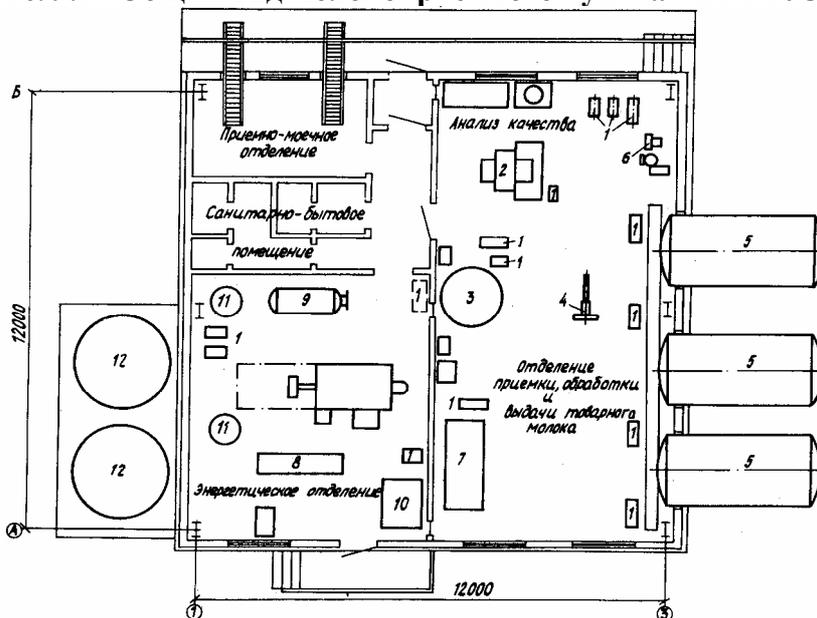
План размещения оборудования молокоприемного пункта в ЛМК:
